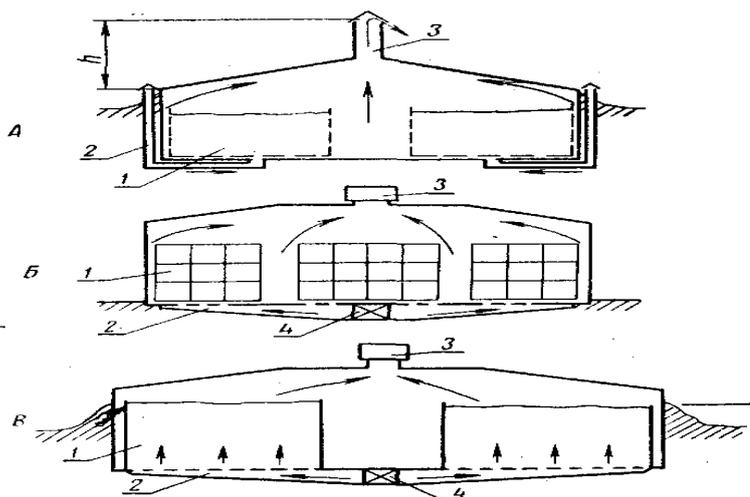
Схемы планировки картофеле-, овоще- и плодохранилища
